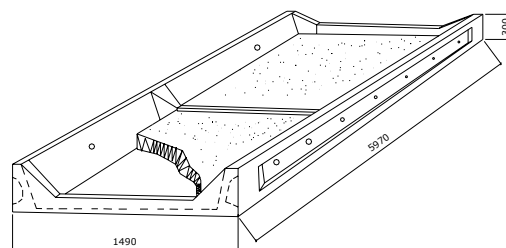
Комплексная керамзитобетонная предварительно напряженная плита с ребрами вверх
